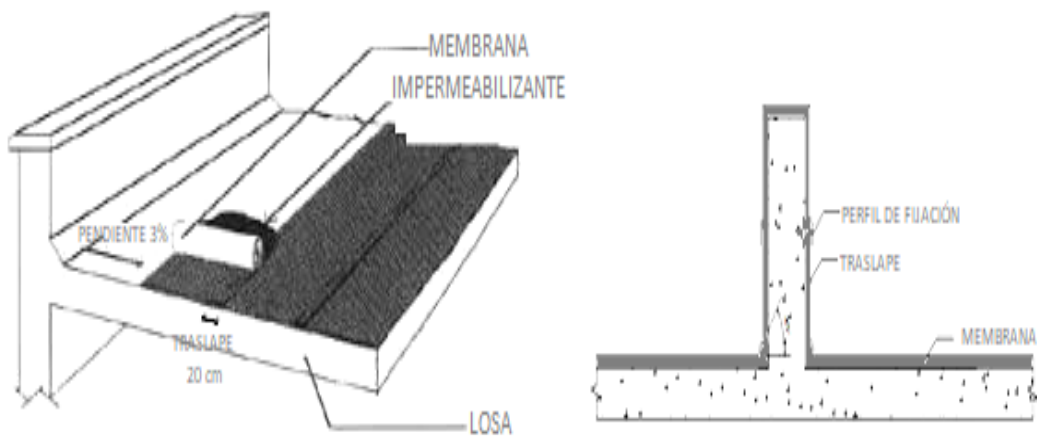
Membrana impermeabilizante, forma de traslape en muro.
